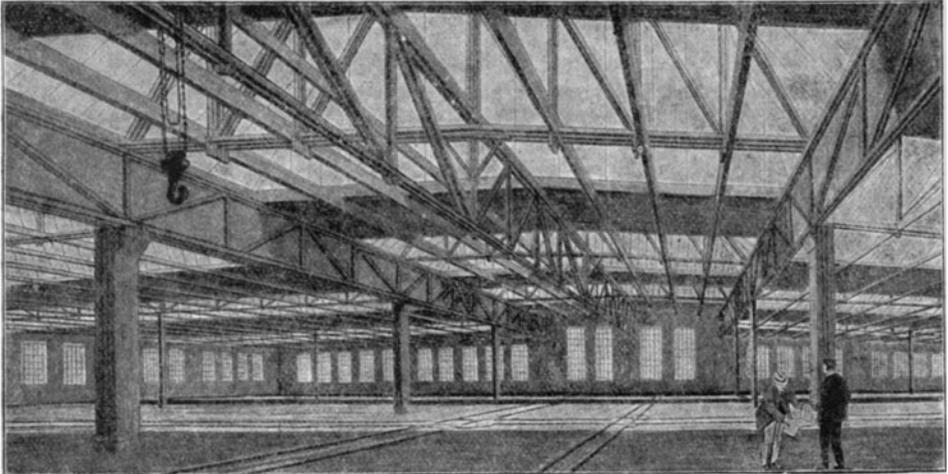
Halle nach der Zeppelin-Hallenbauweise.
